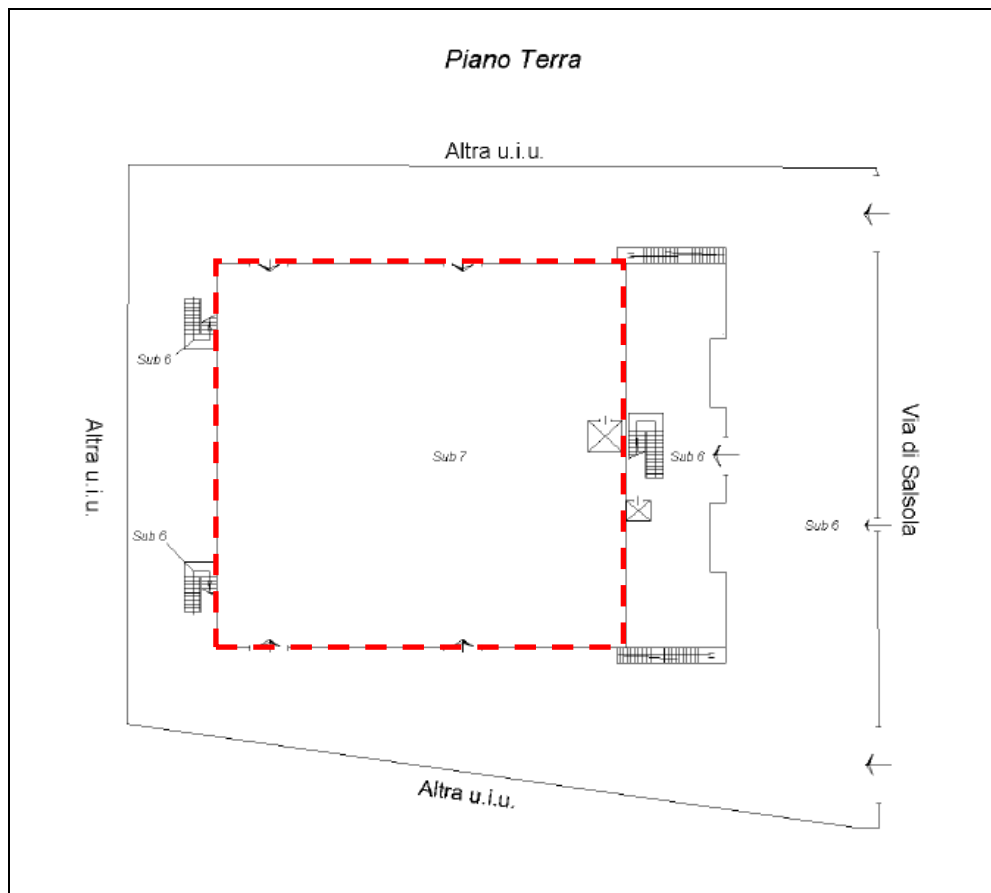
Elaborato planimetrico del pianoterra dell'opificio vigente al 19 aprile 2010 con indicazione dell'unità immobiliare in esame (subalterno 7 della particella 378 foglio n° 75).
